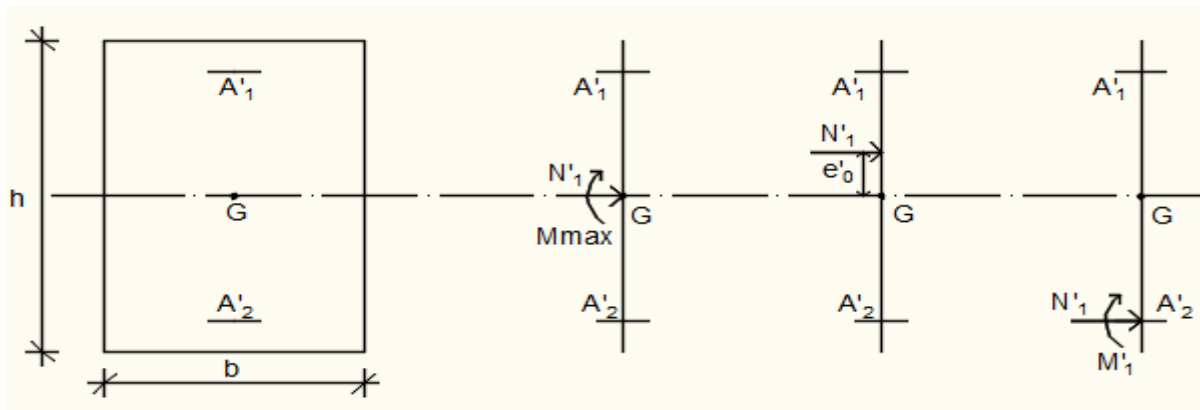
Position de N'_1 , M'_1 et M_1 sur la section transversale.
